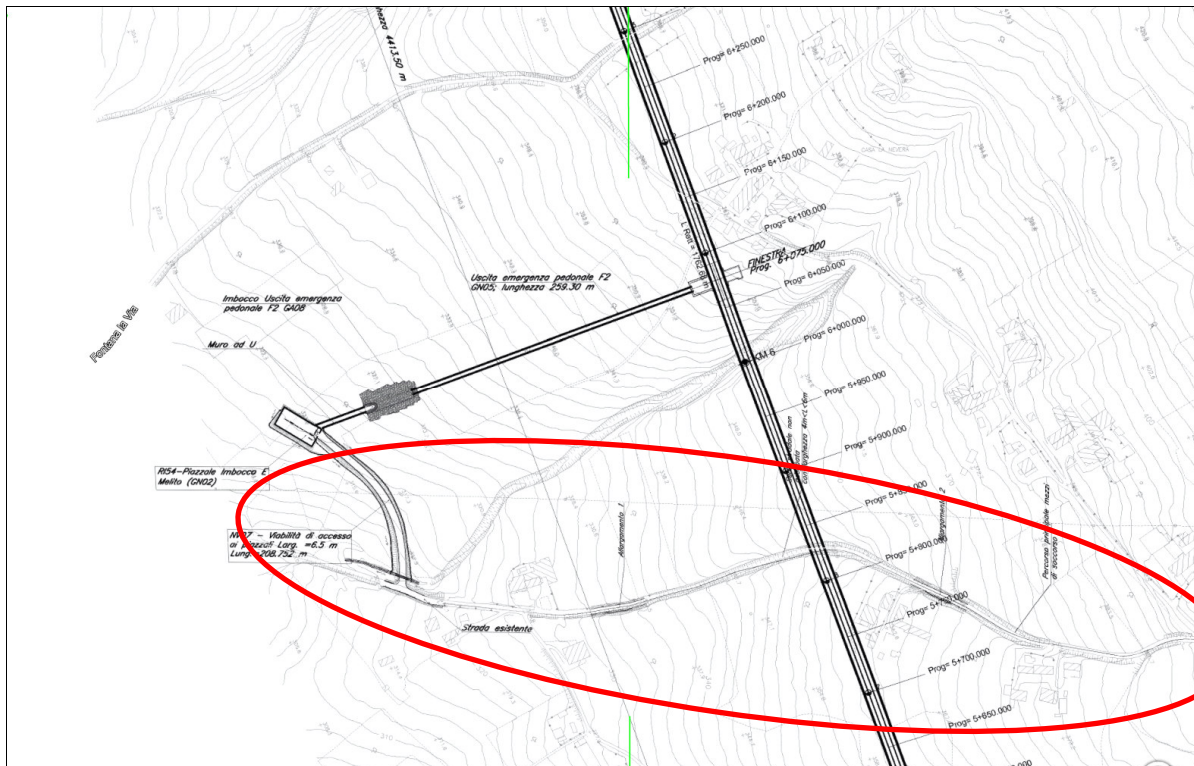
Stralcio planimetrico con l'individuazione dell'intervento
